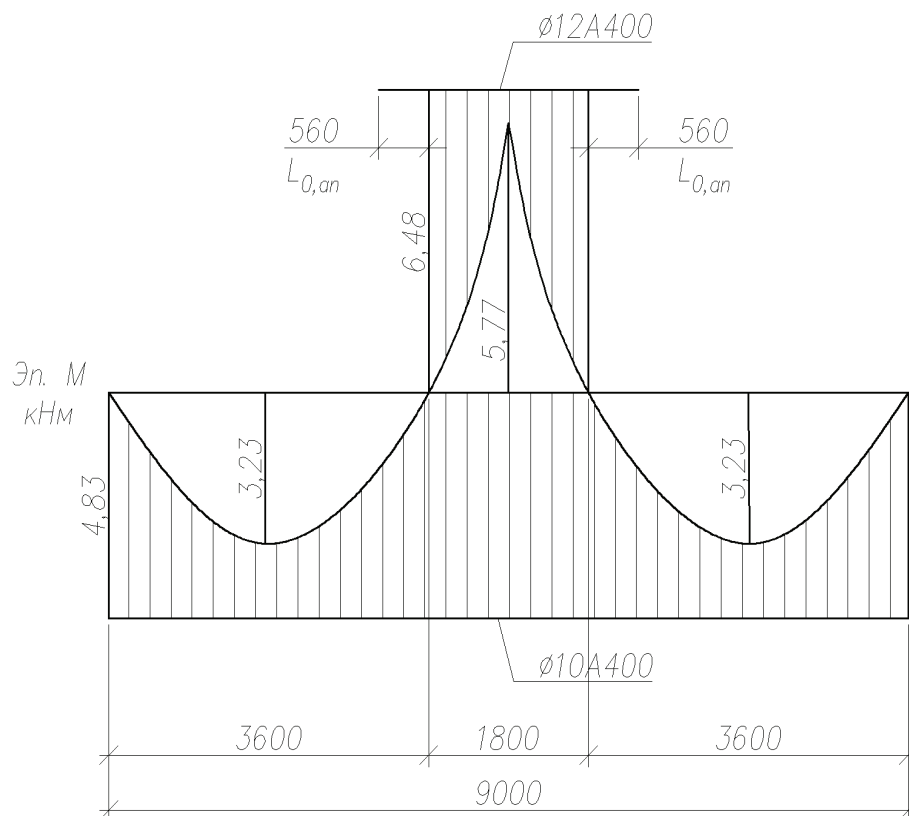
Эпюра материалов одного ребра плиты для 1-го варианта перекрытия
